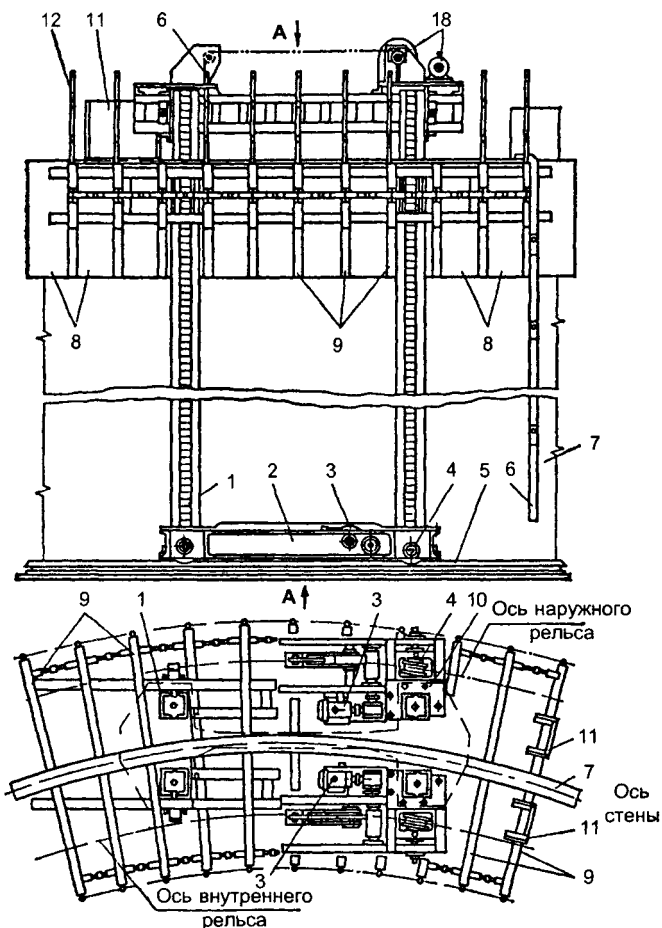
Бетонирование стен цилиндрических емкостных сооружений в универсальной горизонтально скользящей опалубке:
